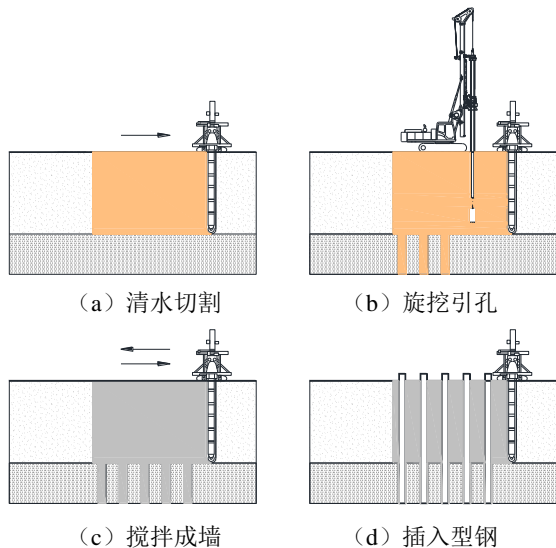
渠式切割混凝土连续墙在软岩施工的流程示意
